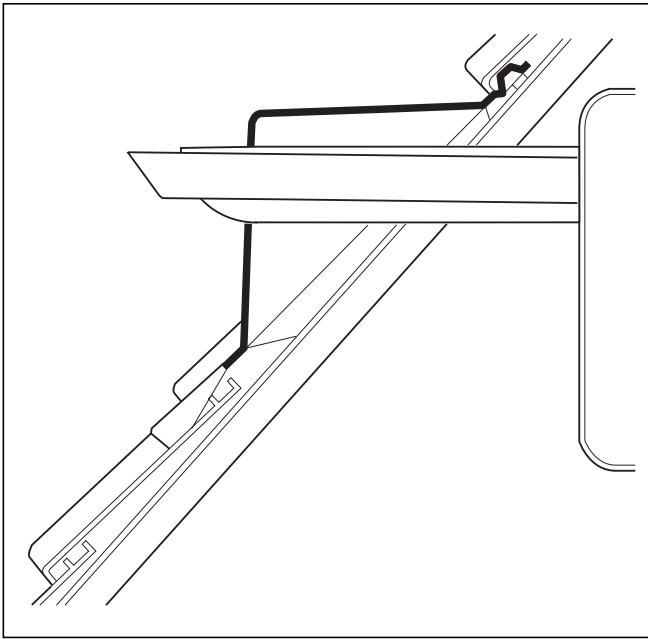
Montagebeispiel waagerechte Dachdurchführung (Dachgaube)
